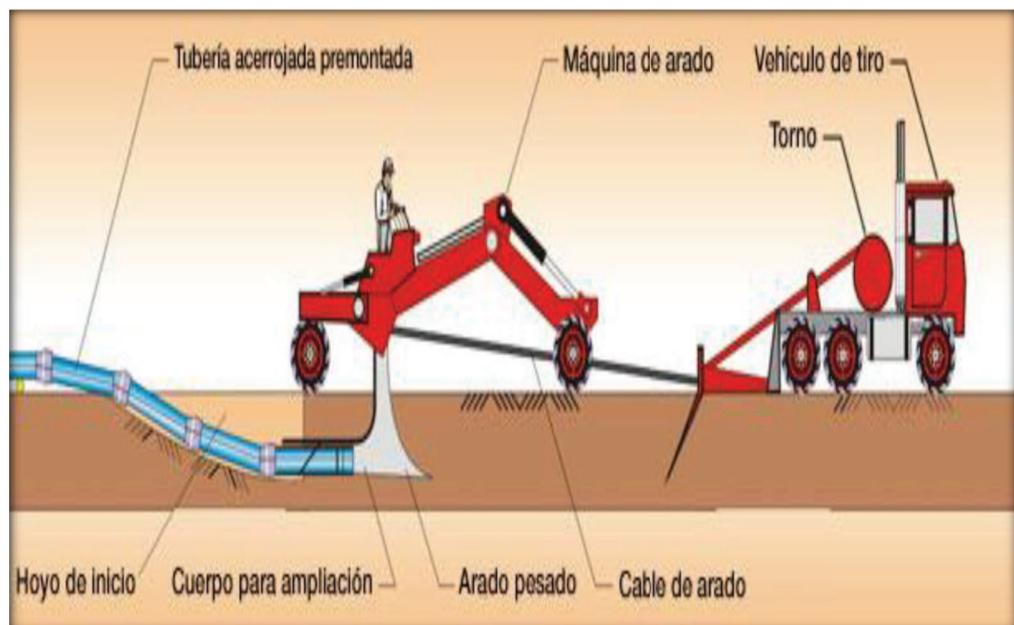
Instalación de tubería nueva: Rocket Plough (Lanzamiento de tubería por arado)
